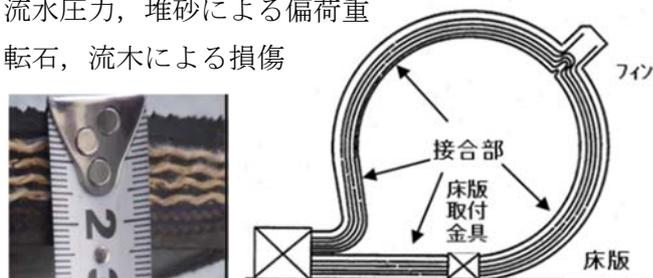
ゴム引布 図-1 ゴム袋体断面(接合部)
